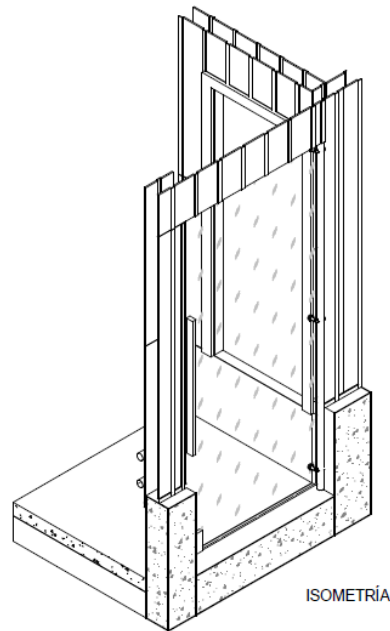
Detalle de puerta en vidrio templado (Plano A17).
